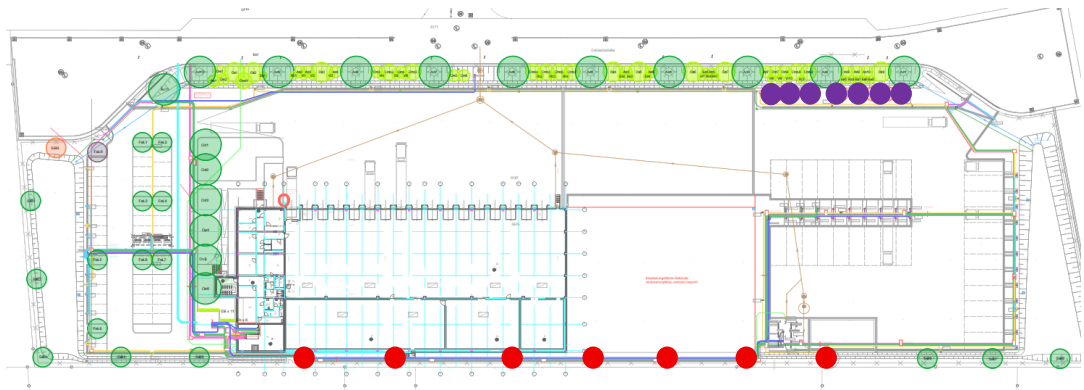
Ausführungsplanung (Außenanlagen – Pflanzungen) abgestimmt mit den Behörden mit entfallenen Bäumen (rot) und geplanten neuen Standorten (lila)
